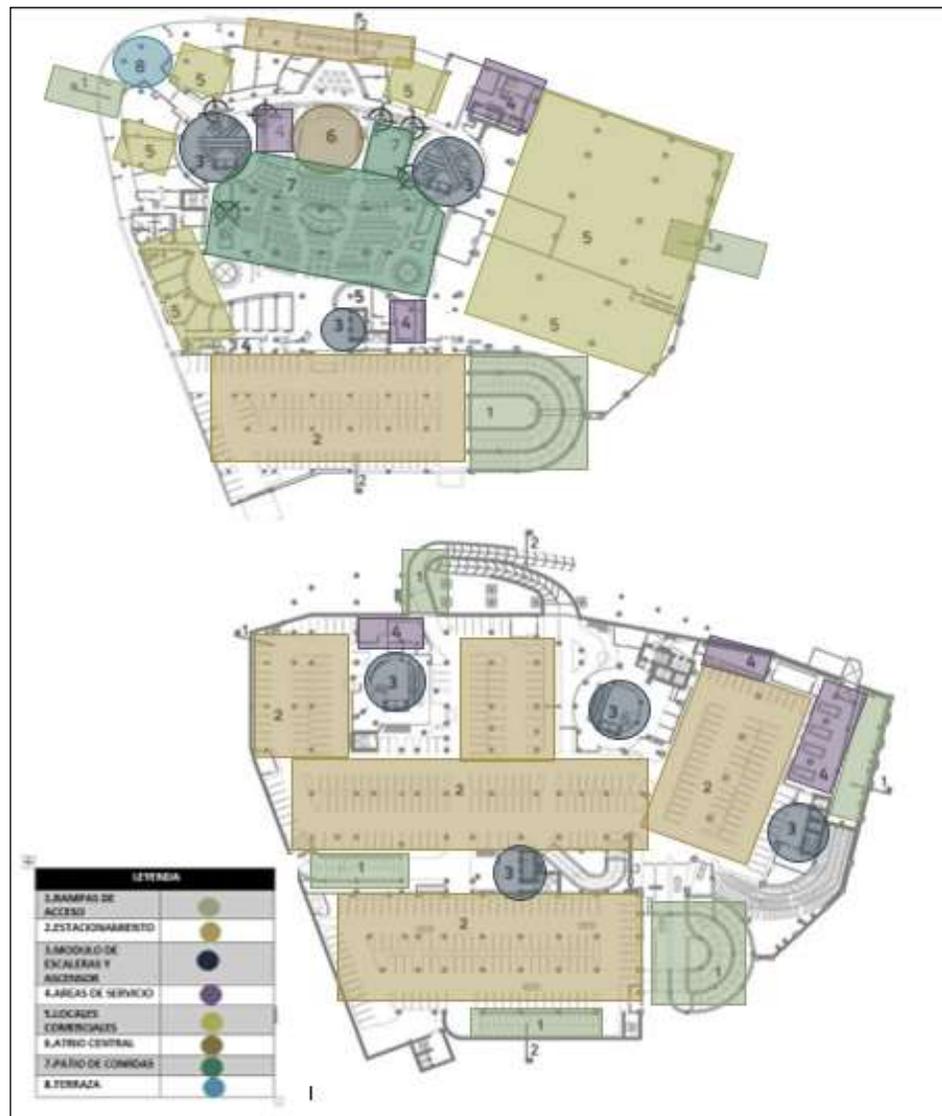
Planta Baja de Centro Comercial Ágora Mall
